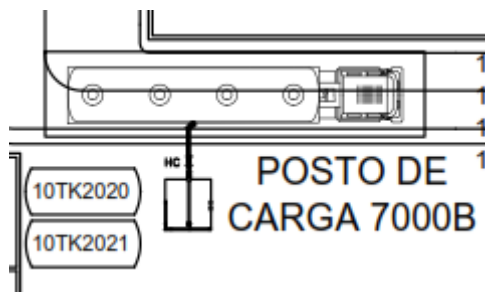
Posto de carga LF – Extracto de “Planta Geral”
